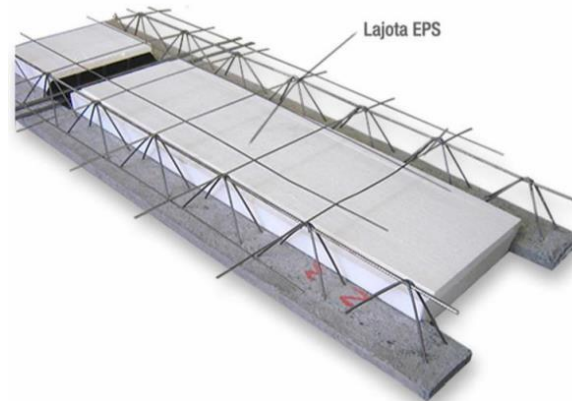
Laje treliçada (Fonte: SALGADO, 2019)
